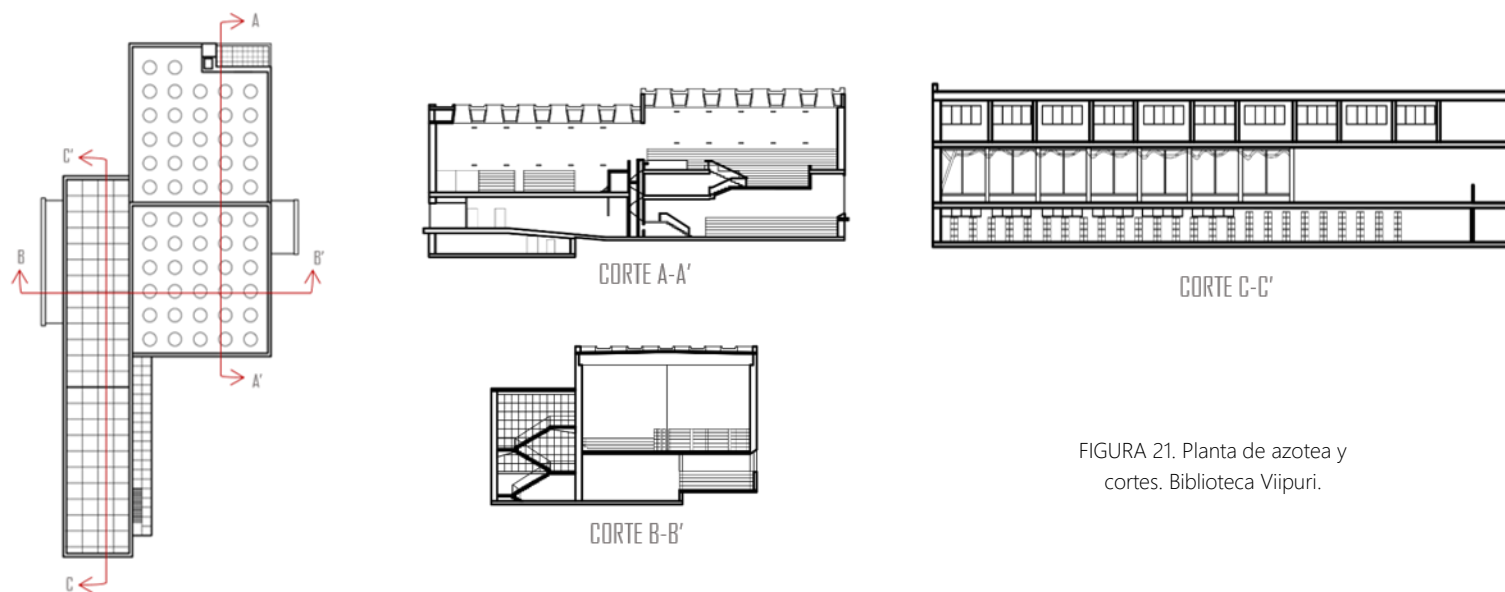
Planta de azotea y cortes. Biblioteca Viipuri.
